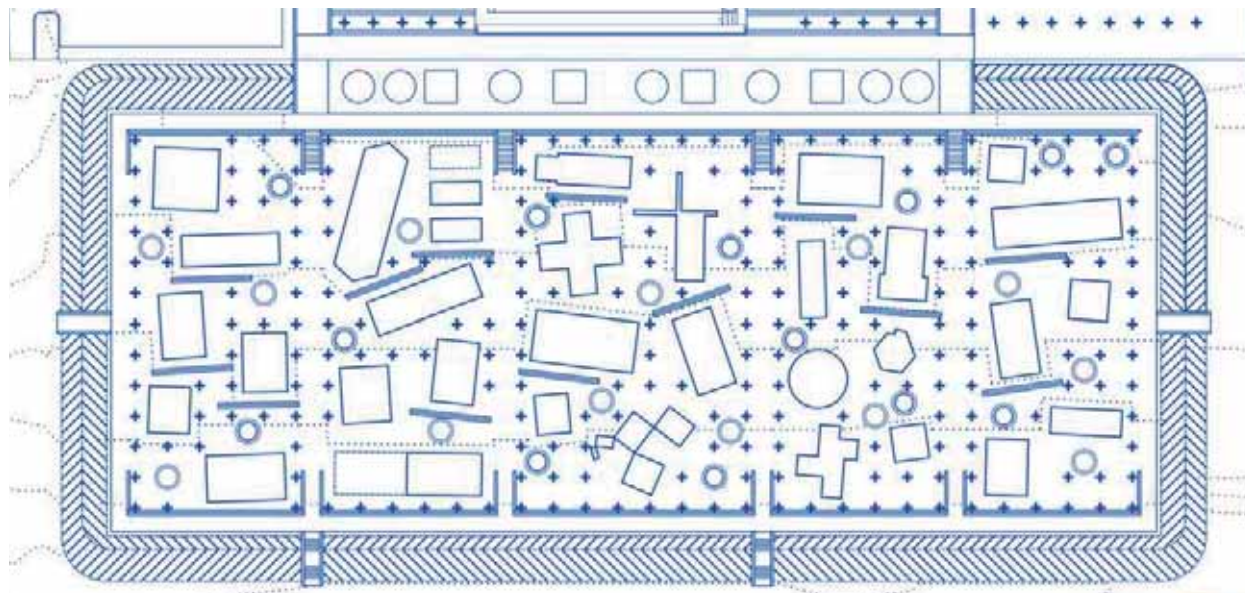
y 89: Laboratorio de vivienda Infonavit en Apan, Hidalgo, Master Plan Laboratorio de Vivienda MOS Architects. Fotografía: Jaime Navarro, Ilustración: MOS Architects. Fuentes: Archdaily, Infonavit.
